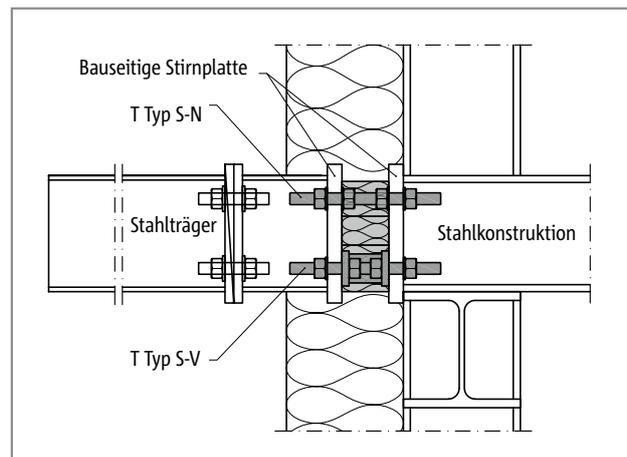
Schöck Isokorb® T Typ S-N und T Typ S-V: Stahlkonstruktion frei auskragend; Adapter bauseitig
